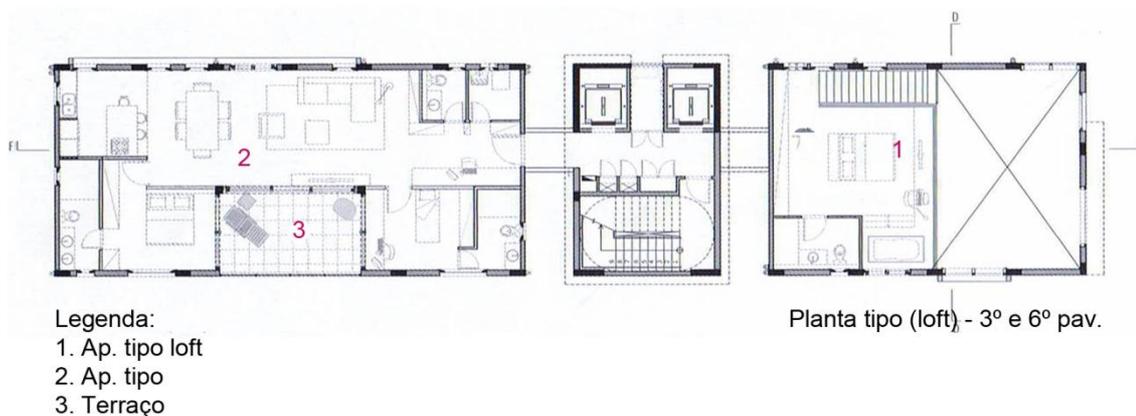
PLANTA TIPO – 3º E 6º PAVIMENTO
